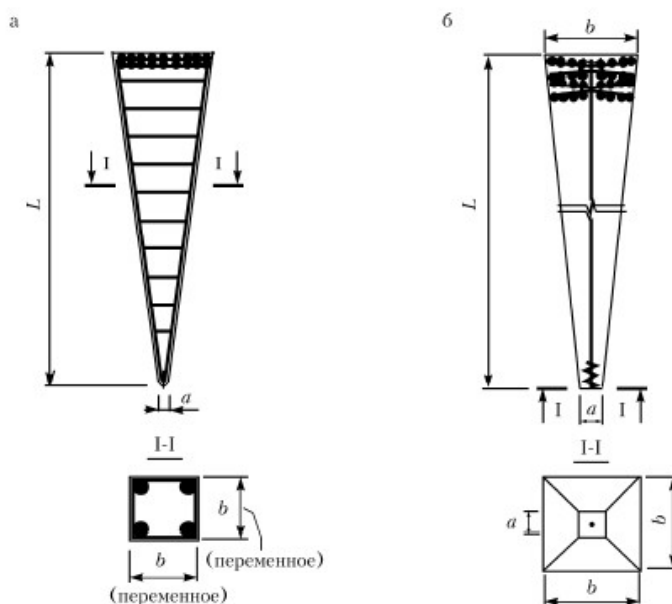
Пирамидальные сваи: а) с поперечным армированием ствола; б) с продольной напрягаемой арматурой [1]
